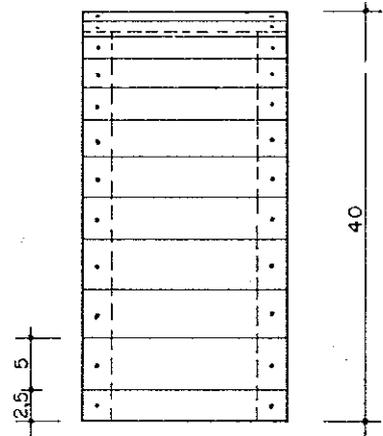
Detalles para construcción del patrón utilizado en la confección de puerta del Horno
